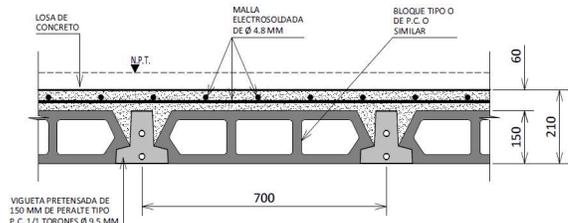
Detalle entpiso colado en apartamentos. Fuente: elaboración propia.
